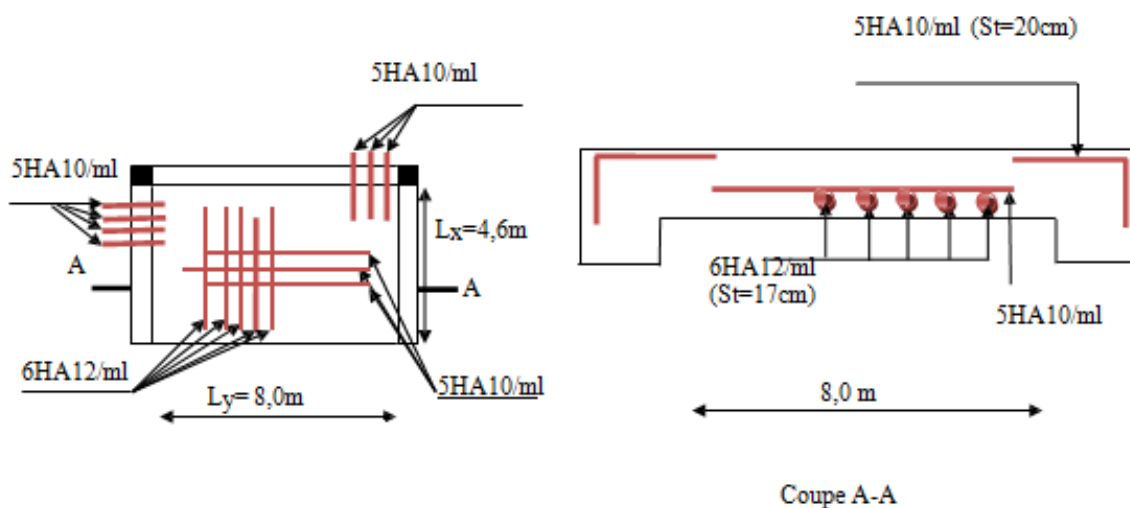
Disposition constructive des armatures des dalles pleine du type1 (RDC & 1er étage).
